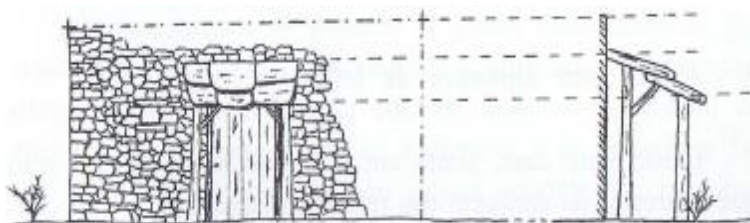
Casa alpendrada com teto de lajes embicadas, assentes em colunas talhadas na pedra do Moimento ou das lajes dos Chões. Construção mais recente relativamente à anterior (Abrantes, Pinto e Carvalho 1993)
